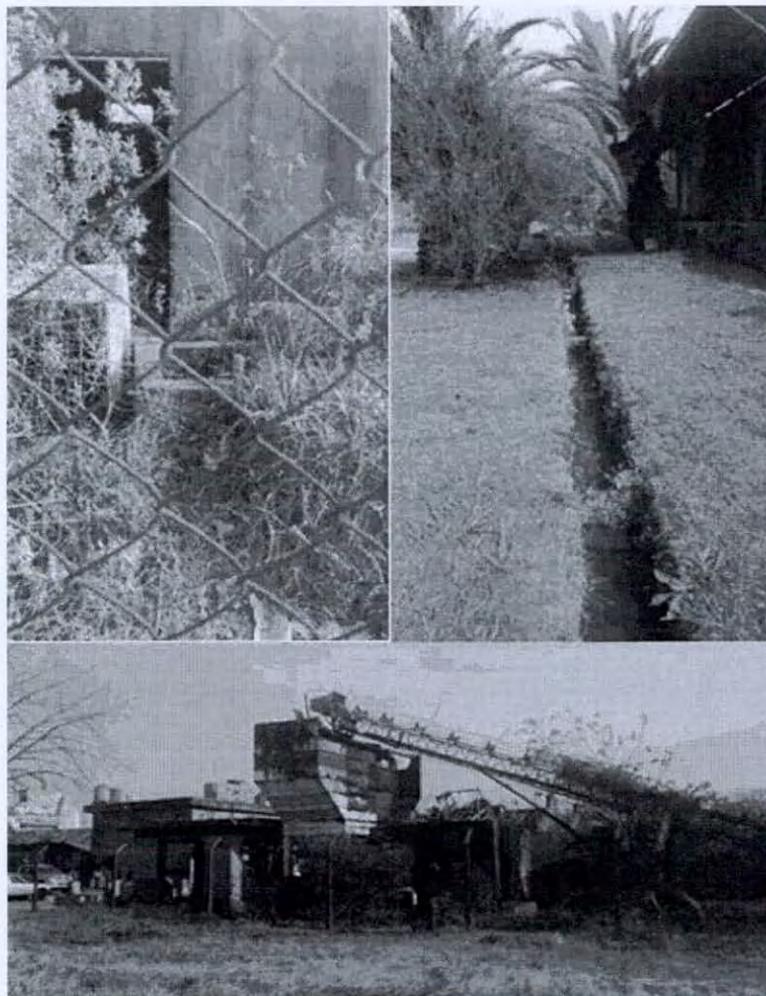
Vista de los restos de la planta de Hormaco. Posible perforación para agua y canal colector en Planta de Hormaco
